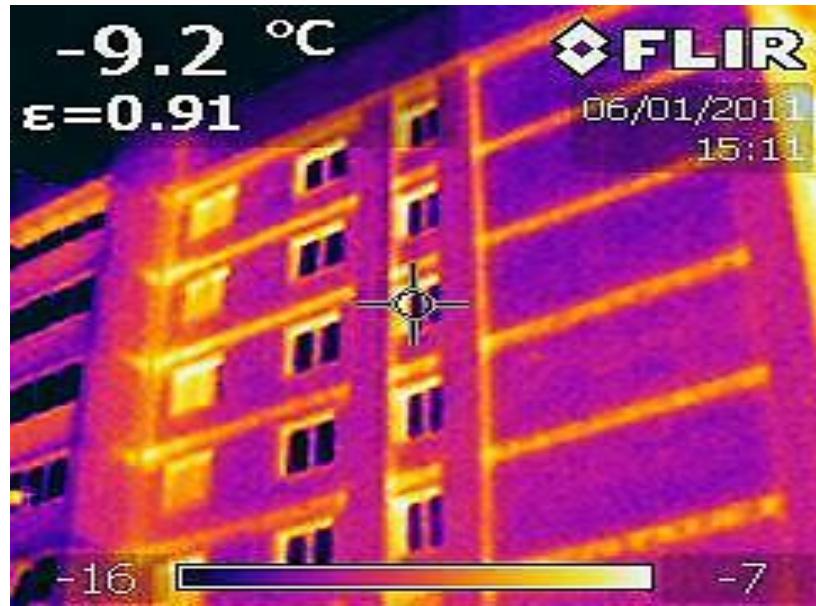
Теплопотери через торцы железобетонных плит перекрытий и перемычки
